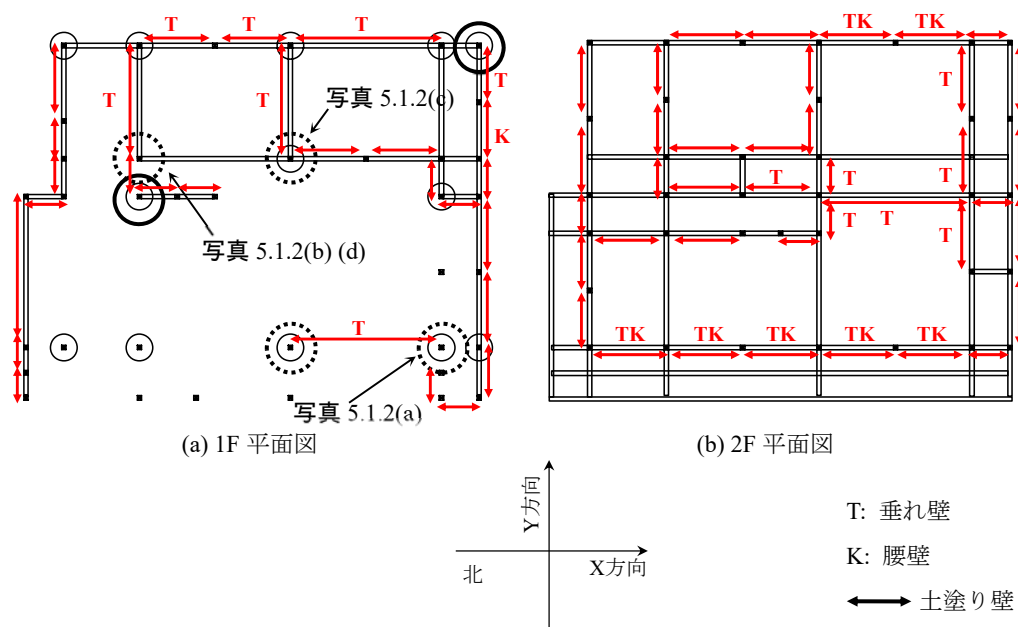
B 邸の既存部分の平面図、耐震要素
